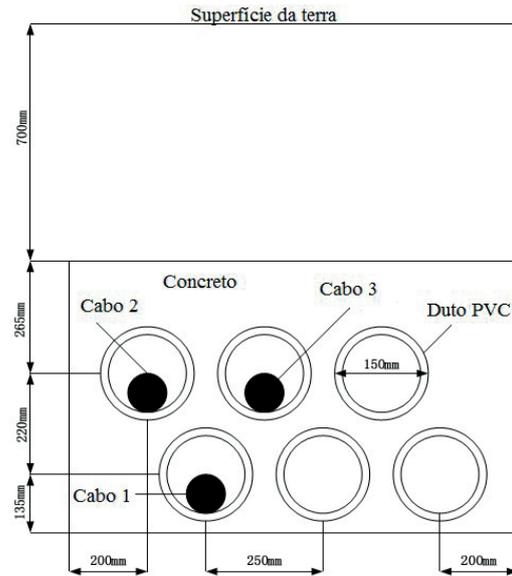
Configuração dos cabos nos eletrodutos de PVC envolvidos em concreto – Adaptado da referência LIANG, Y
